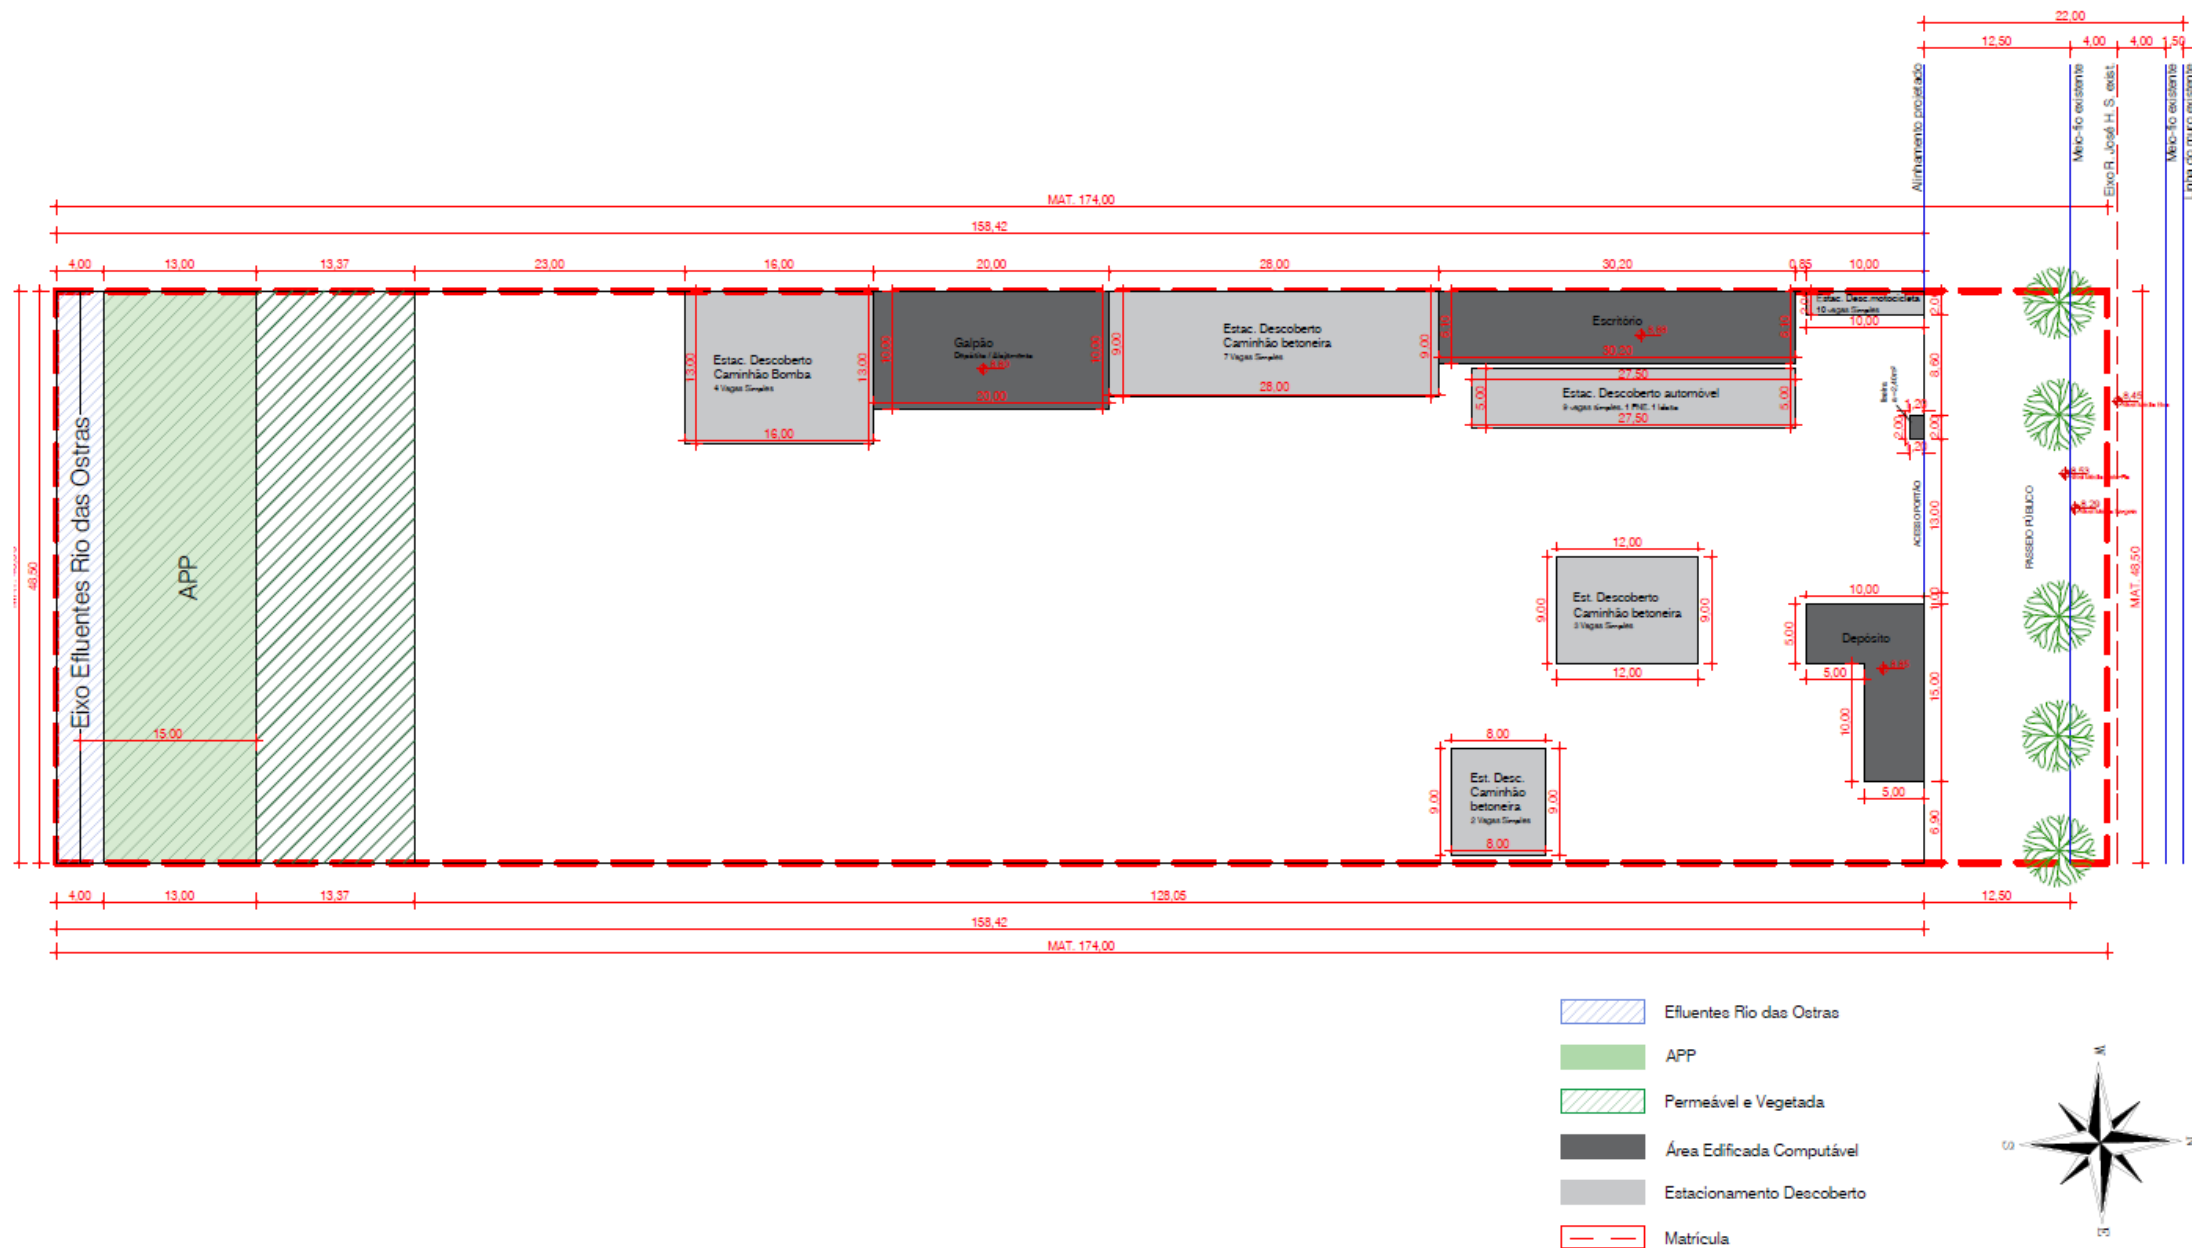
Planta de implantação do empreendimento observando o distanciamento da APP. Fonte: Autor, 2025.
